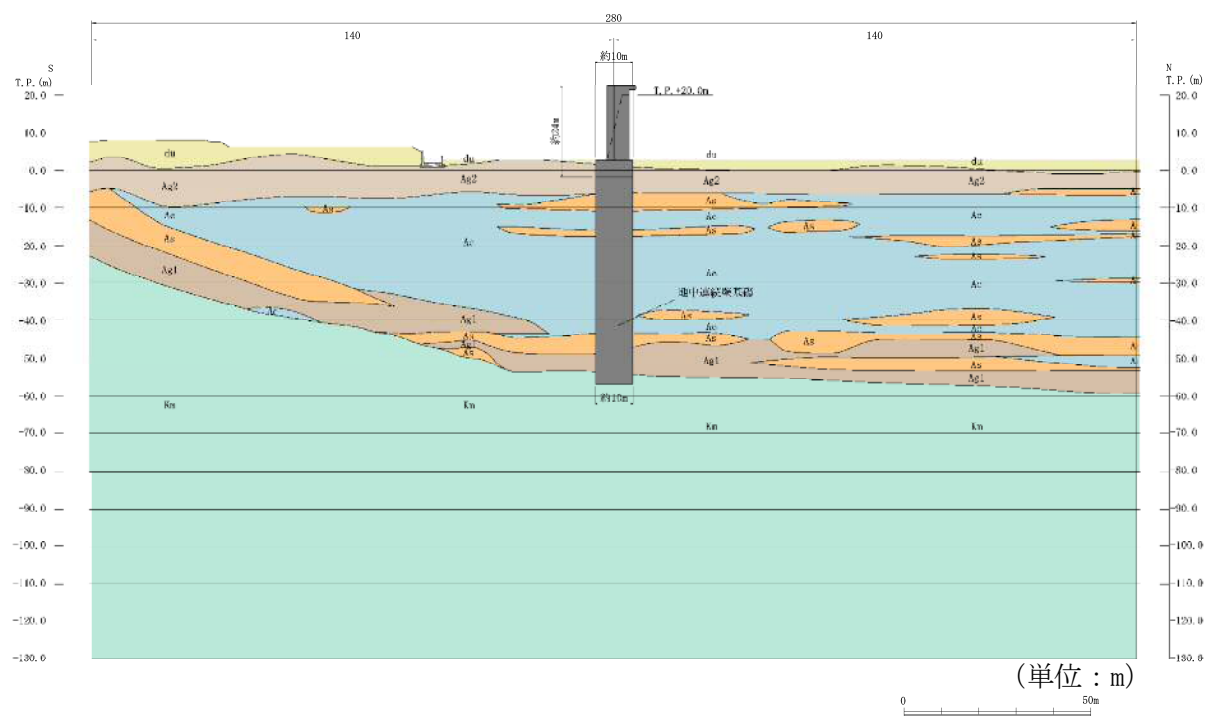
(7) 鉄筋コンクリート防潮壁 断面図(G-G断面)
